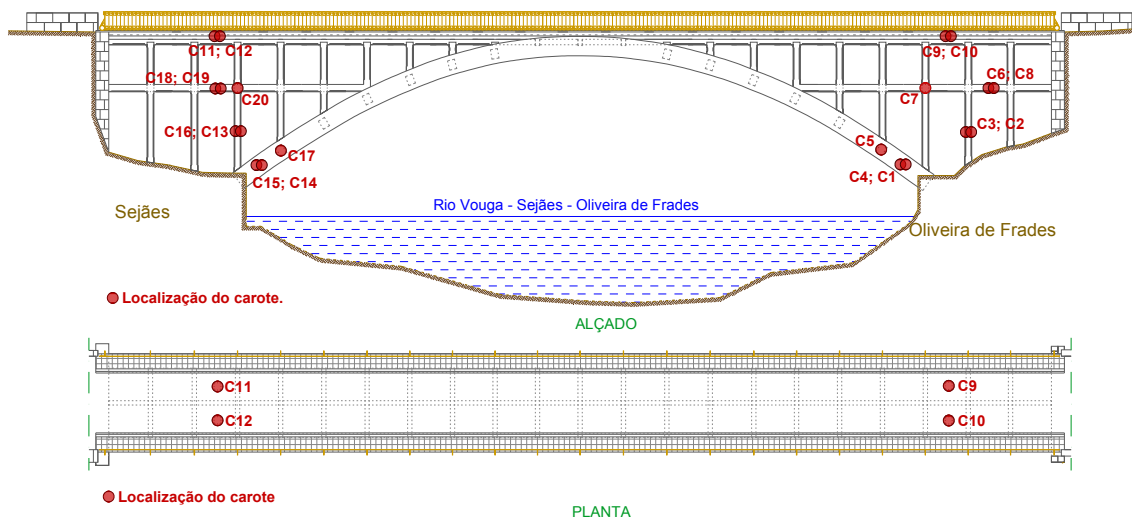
Vista em alçado e em planta da localização dos diversos carotes.
